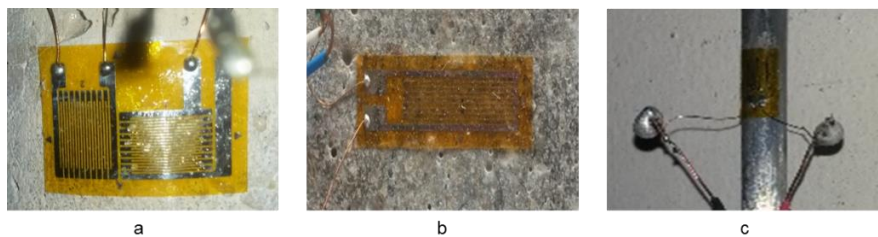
Extensômetros: (a) PA-06-250TG-120-L; (b) PA-06-250BA-120-L; (c) PA-06-800BA-120-L.
